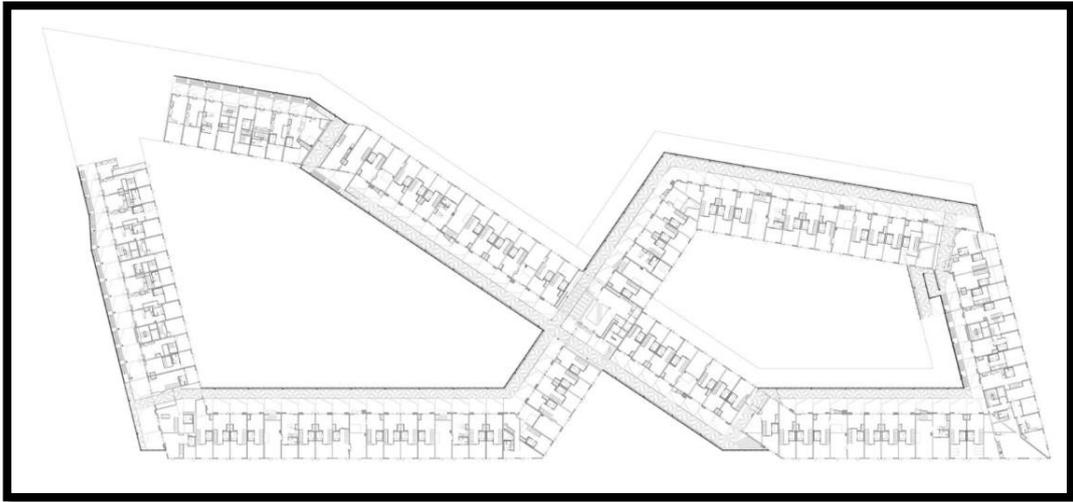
plan du 8 jusqu'à 10 eme étage.
